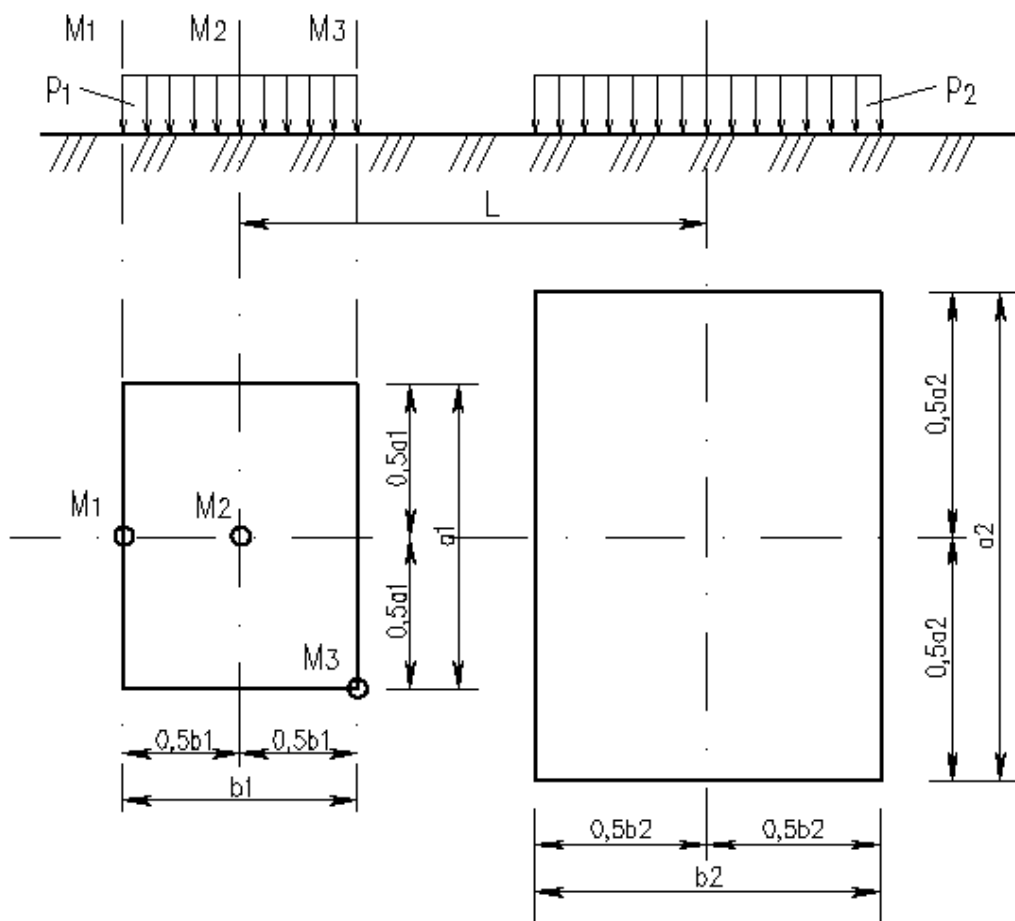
Схема к расчету напряжений в грунте методом угловых точек
